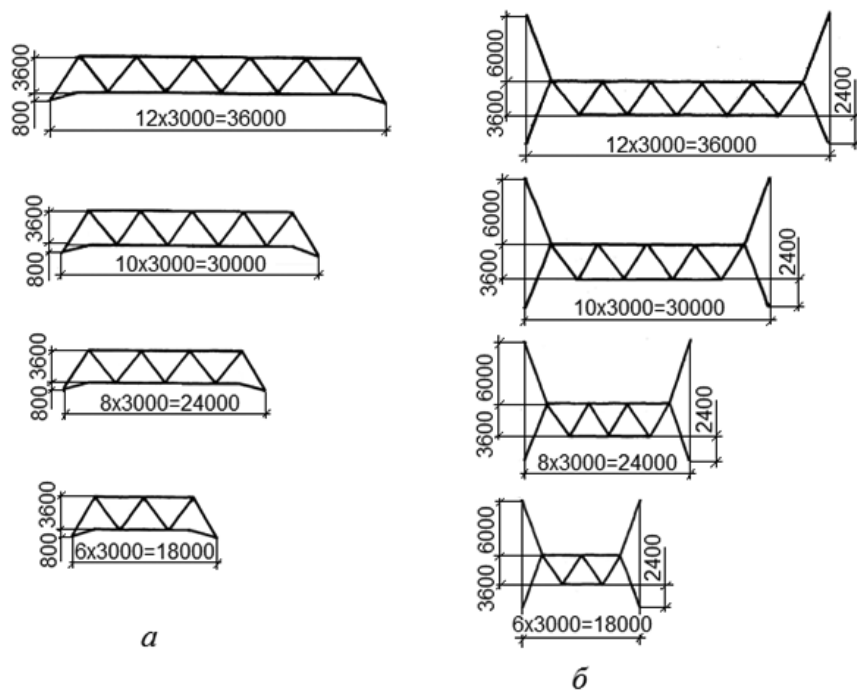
Схемы горизонтальных связевых ферм при шаге стропильных ферм:
